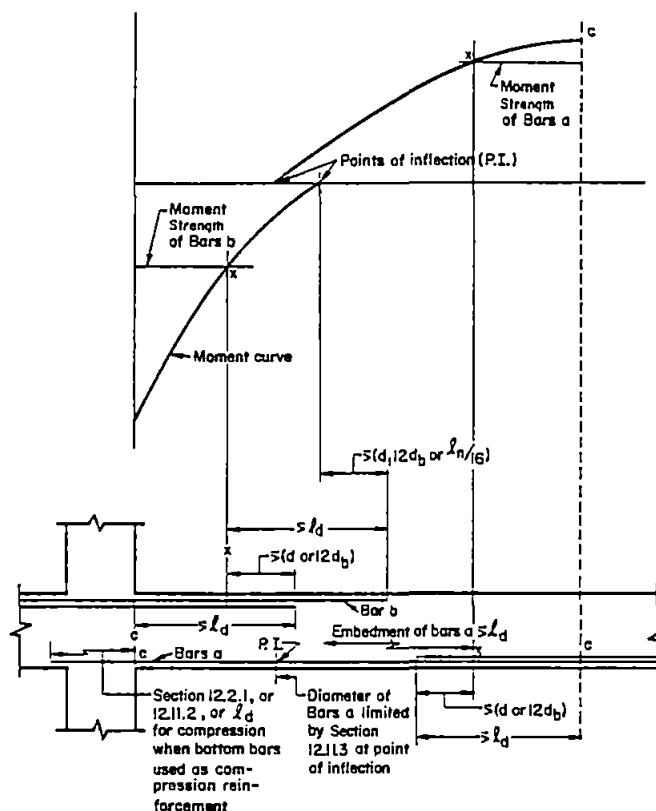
Longitud de desarrollo de la armadura sujeta a flexión en una viga continua.
